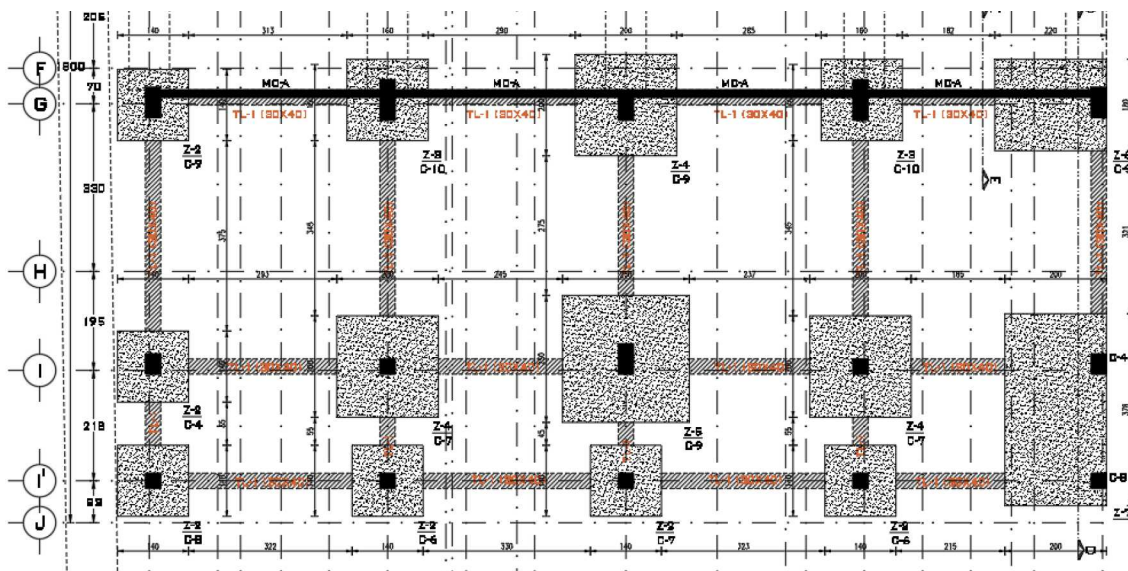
Distribución de la cimentación, el tipo de sistema constructivo tipo ZAPATA AISALADA, de acuerdo con el comportamiento de carga, con respecto al suelo.
